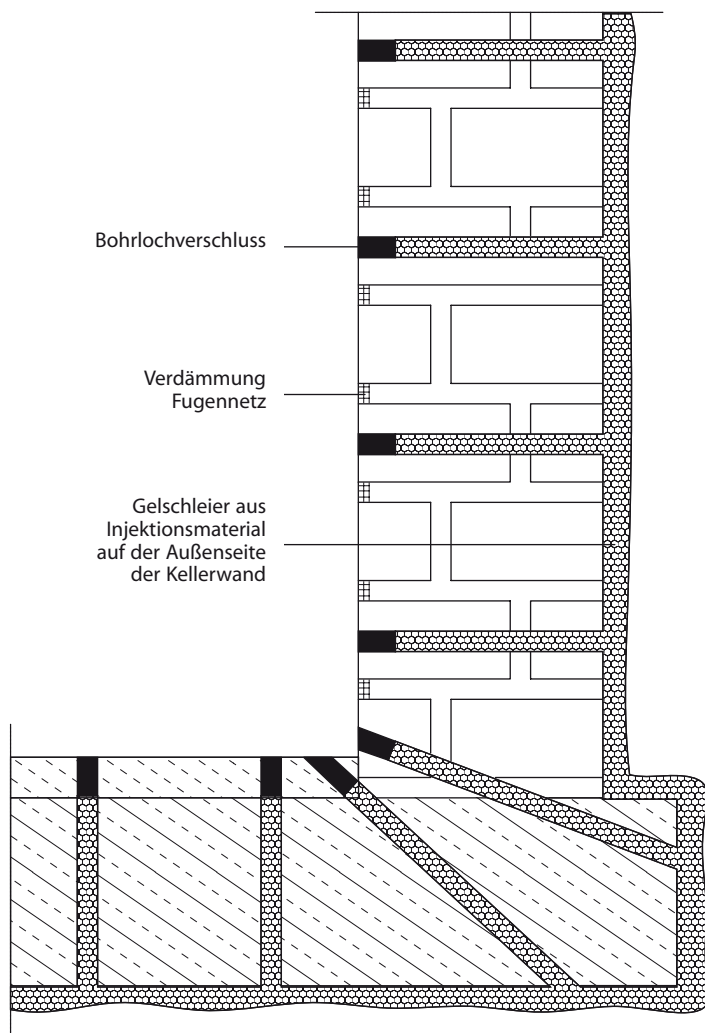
Vertikale Flächenabdichtung erdberührter Außenwände durch Gelschleier-Injektion (Prinzipiskizze)
